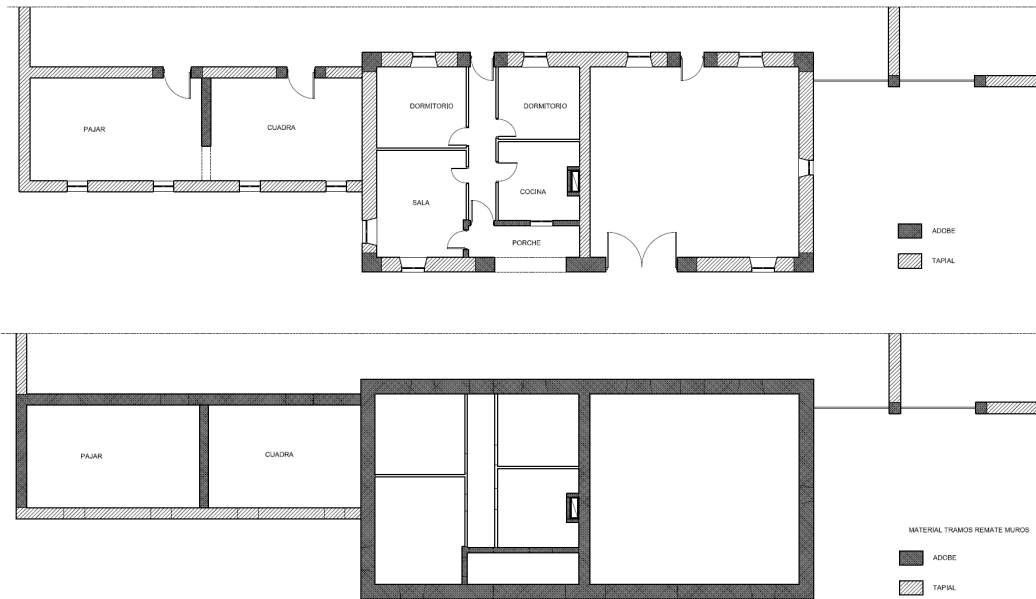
Plano de las estancias cerradas de la obra. Se indican en oscuro los refuerzos realizados mediante adobes en el cuerpo principal de los muros. Su anchura es de dos pies en las esquinas del bloque de las viviendas, de pie y medio en las jambas de las puertas. Fuente: F. Javier Carbayo.
